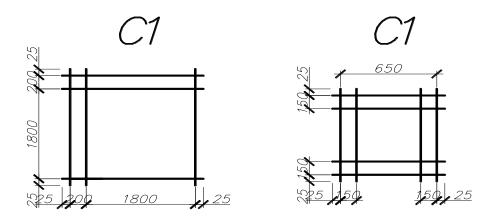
Армирование фундамента, выполненное в сечении 1-1
